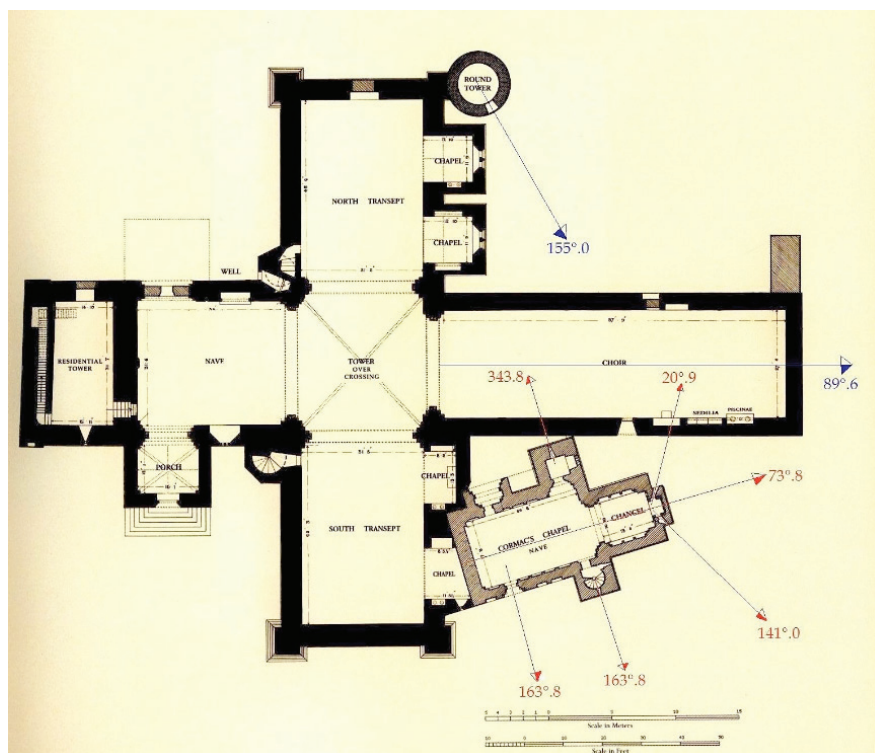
Planimetria del complesso di Cashel con gli azimut misurati il 24 agosto 2006.
